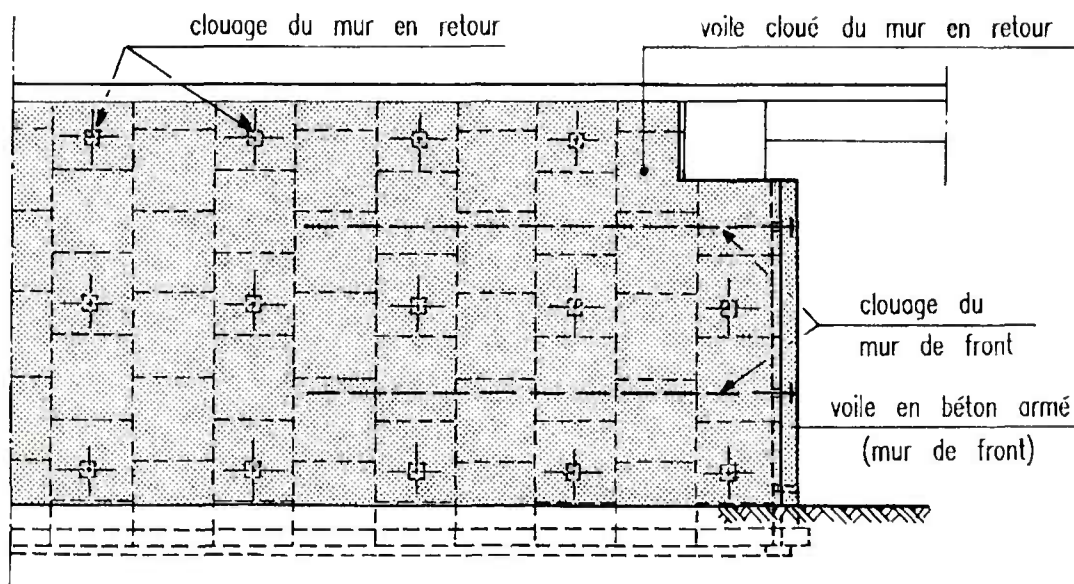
Renforcement d'une culée par clous horizontaux et voiles
